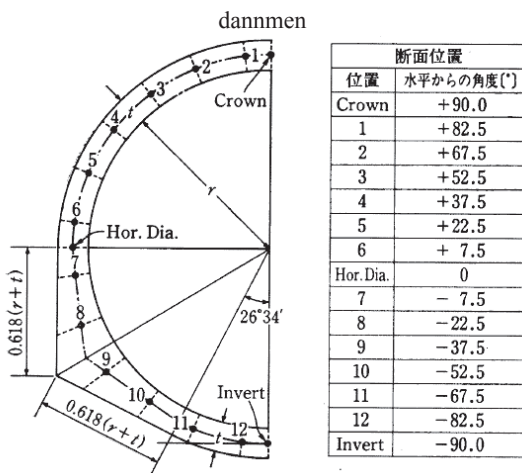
円形トンネル半断面図 (浅井, 1992) Halfsection of circular culvert
